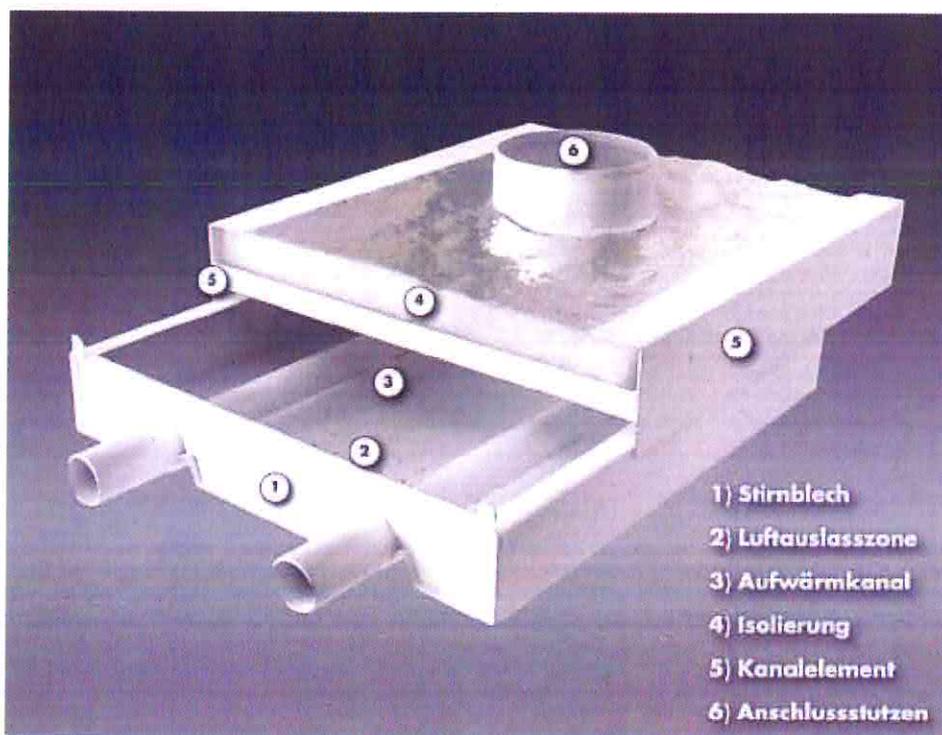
Deckenstrahlplatte in Kombination mit Lüftung
